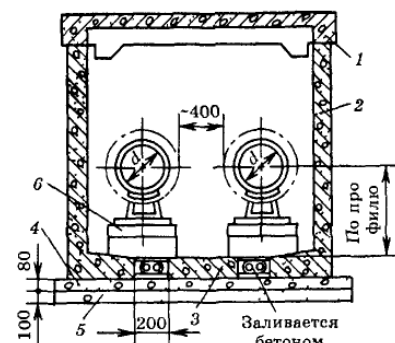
Сборный полупроходной канал из железобетонных блоков
